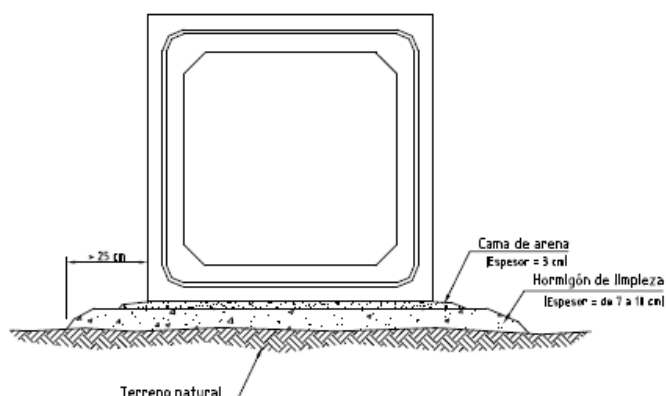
Apoyo y colocación de los marcos prefabricados
